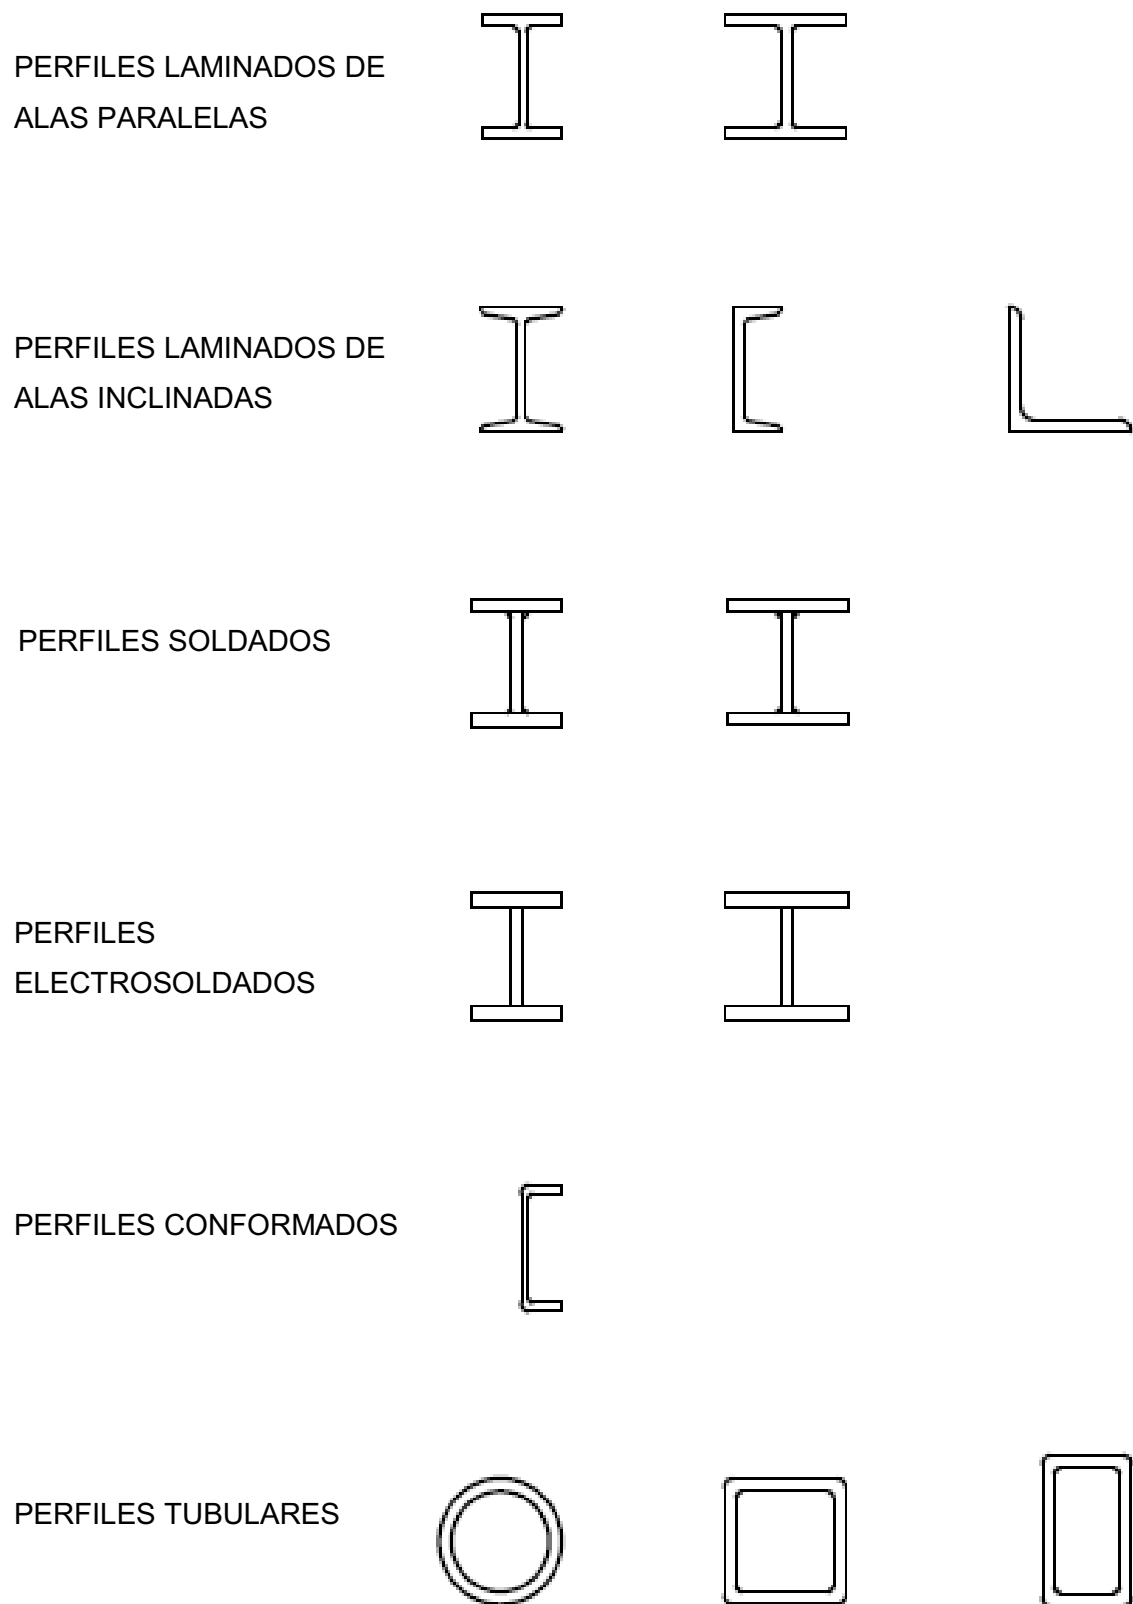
Tipos de perfiles utilizados como vigas, traveses y columnas.
